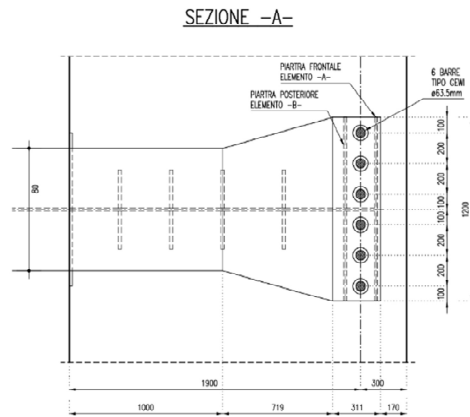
Dettaglio carpenteria metallica nodo spalla-impalcato, vista dall'alto
